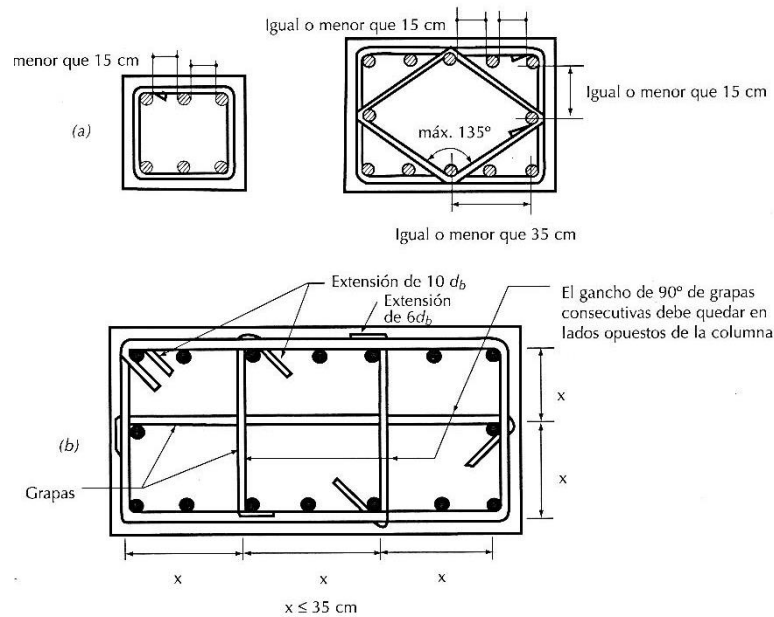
Detalles de refuerzo transversal de columnas.
